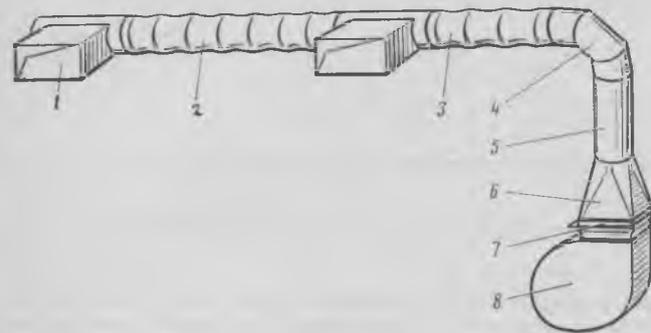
Схема вентиляционной системы: 1 — насадка; 2, 3 — гибкие воздуховоды; 4 — отвод; 5 — воздуховод; 6 — переход; 7 — шибер; 8 — центробежный вентилятор
